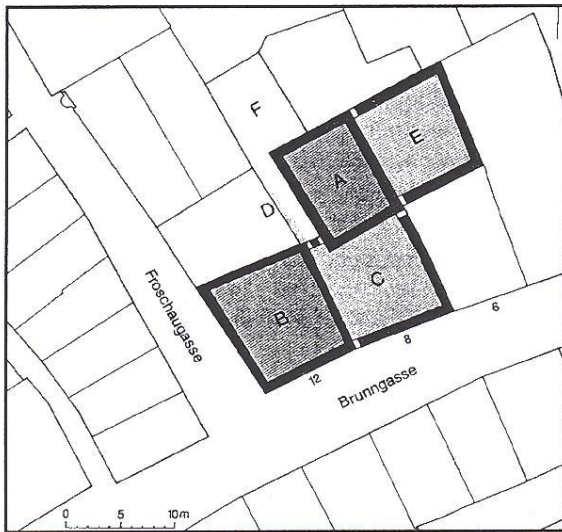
Grundrissentwicklung der Häuser Brunngasse 6-12 (BdD, S. 30)
